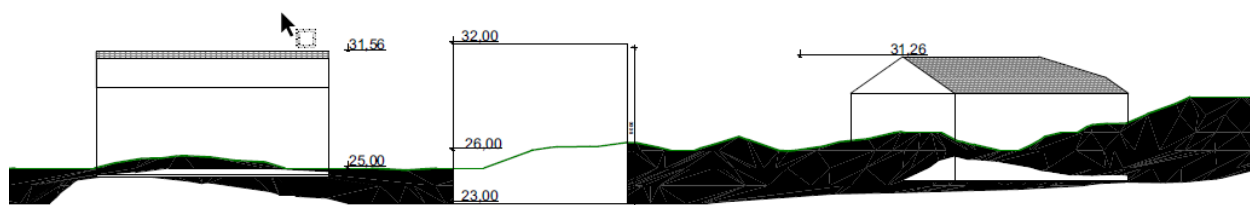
Planforslagets skisse til bebyggelse på BKS3
